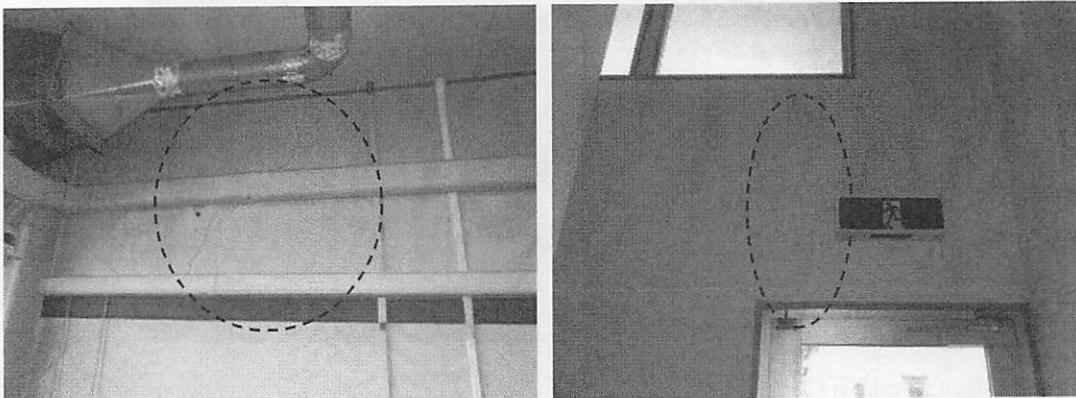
建物のひび割れの状況（左：長浜庁舎 本館、右：長浜庁舎 実験棟）
